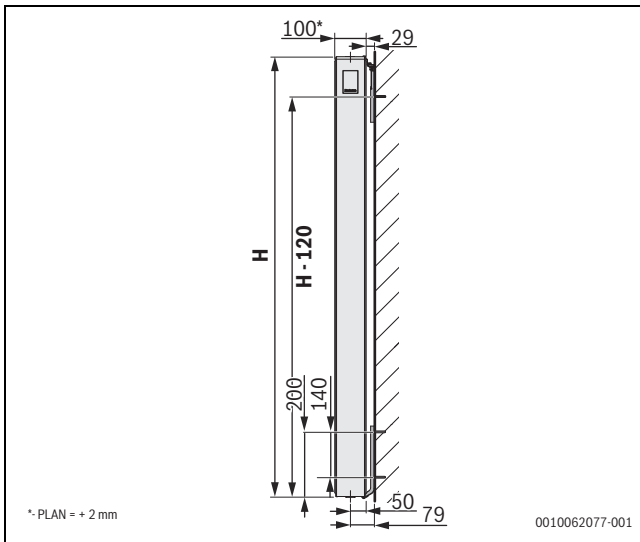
Heizkörperinstallation Typ 22 für VC-, VCM-, C-Profil/Plan. 2
